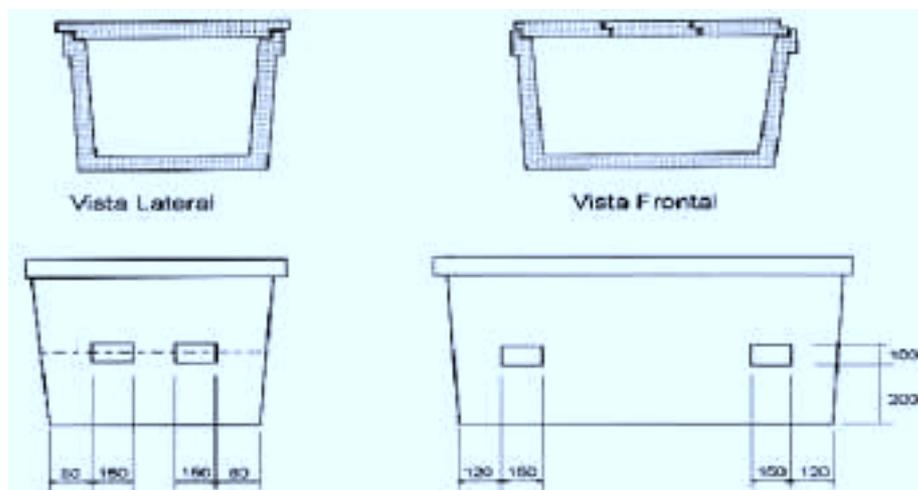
Cortes de las Cámaras de Hormigón Premoldeadas
